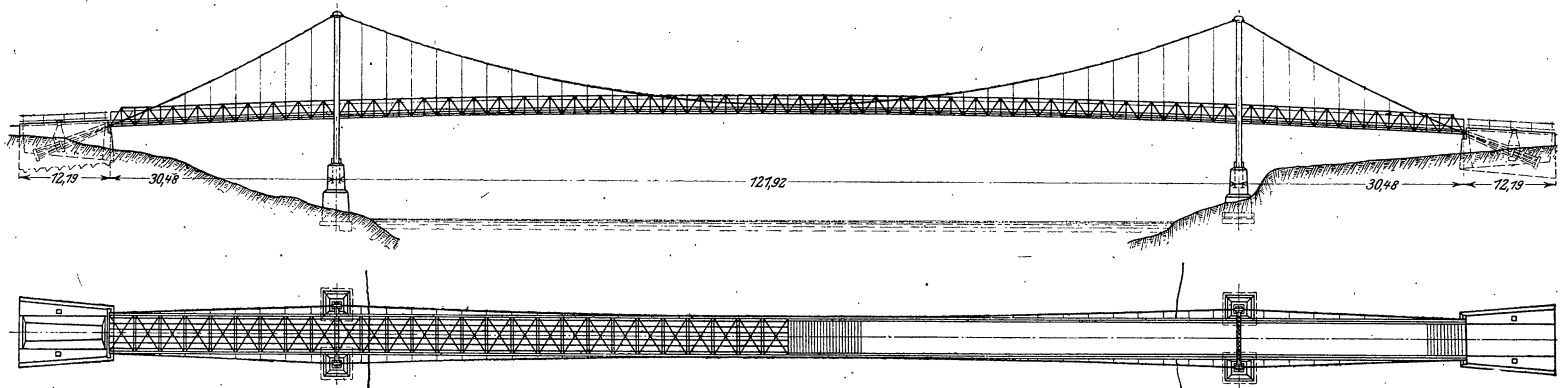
und 2. Aufriß und Grundriß der Brücke. Maßstab 1:1000.
